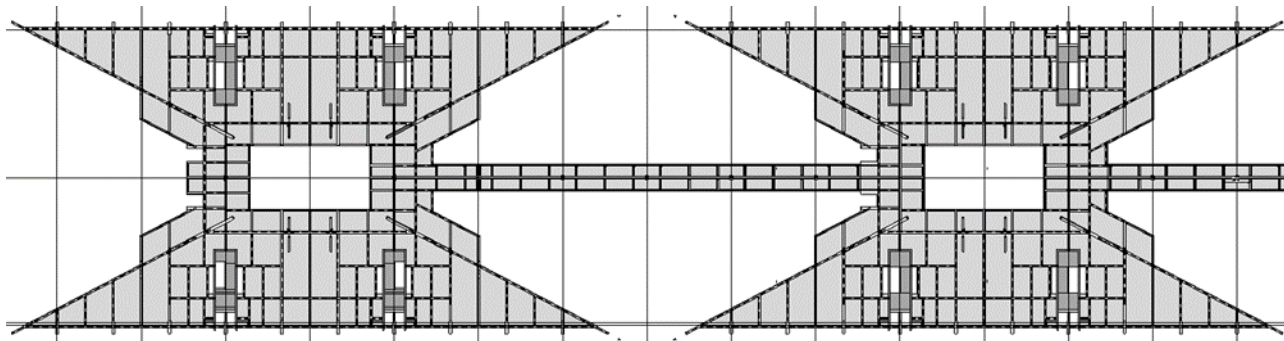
Impalcato LC1, moduli centrali: vista in pianta
